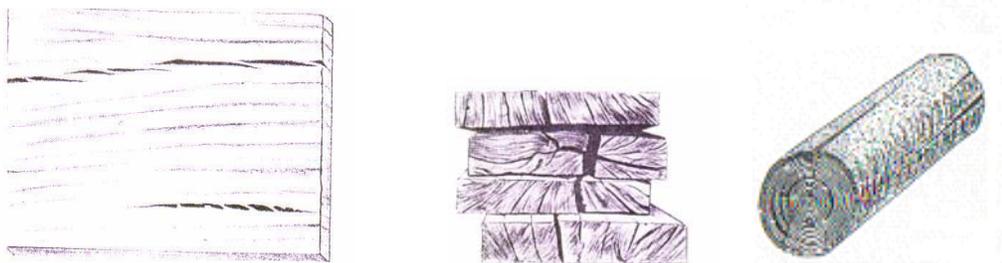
Rajaduras, grietas y acebolladuras.
